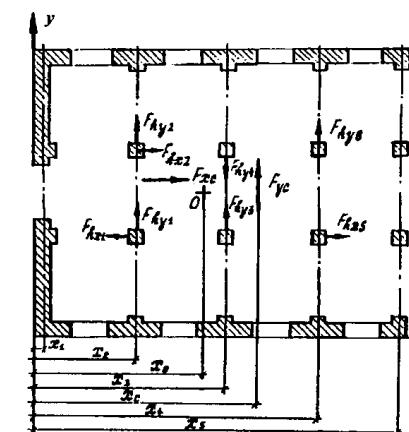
План температурного блока здания с упругой конструктивной схемой к определению дополнительных горизонтальных усилий от наклона столбов и стен
